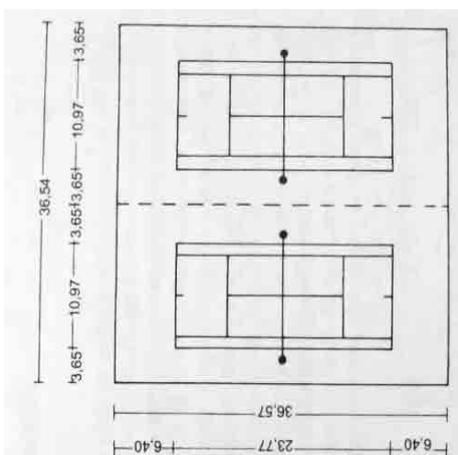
Planta baixa quadra de tênis. Fonte: NEUFERT (2016).
